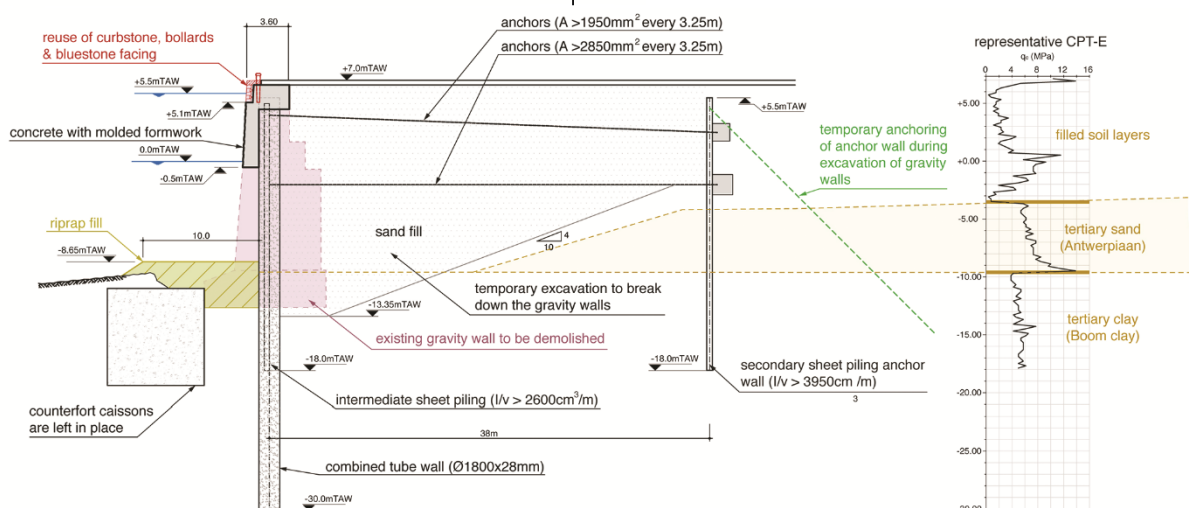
Solução de Estabilização no Cais D'Herbouvillekaai - Fonte: Hillewaere e Feremans, 2016
